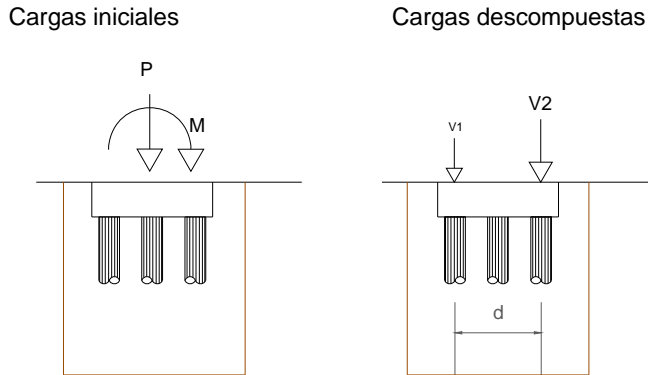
Cargas iniciales grupo de tres pilotes y cargas descompuestas para cálculo.
